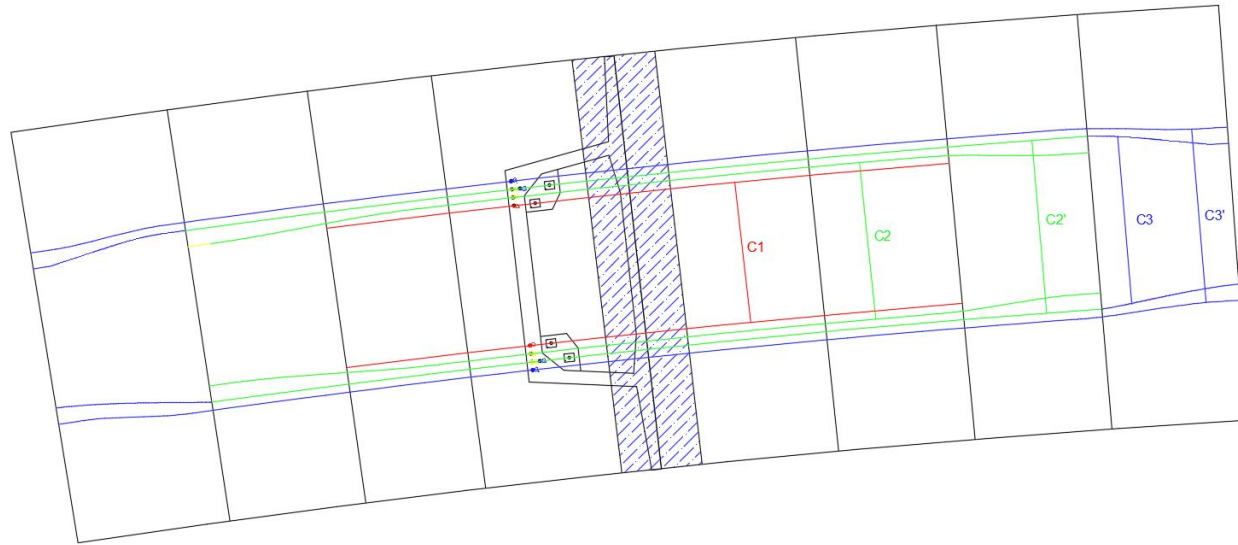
Tracé en plan de câbles de continuité de travée principale
